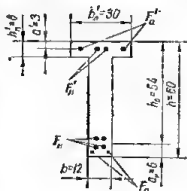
Схема расположения арматуры в сечении предварительно напряженной железобетонной балки.
